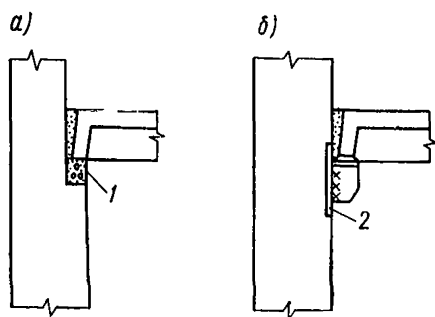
Примеры опирания междуэтажных перекрытий на уступ (а) и стальной столик (б) наружных стен
